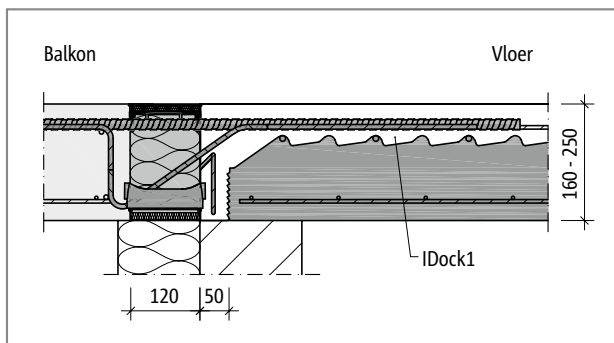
Schöck Isokorb® CXT type K-E: aansluiting bij randbalk en ETICS
